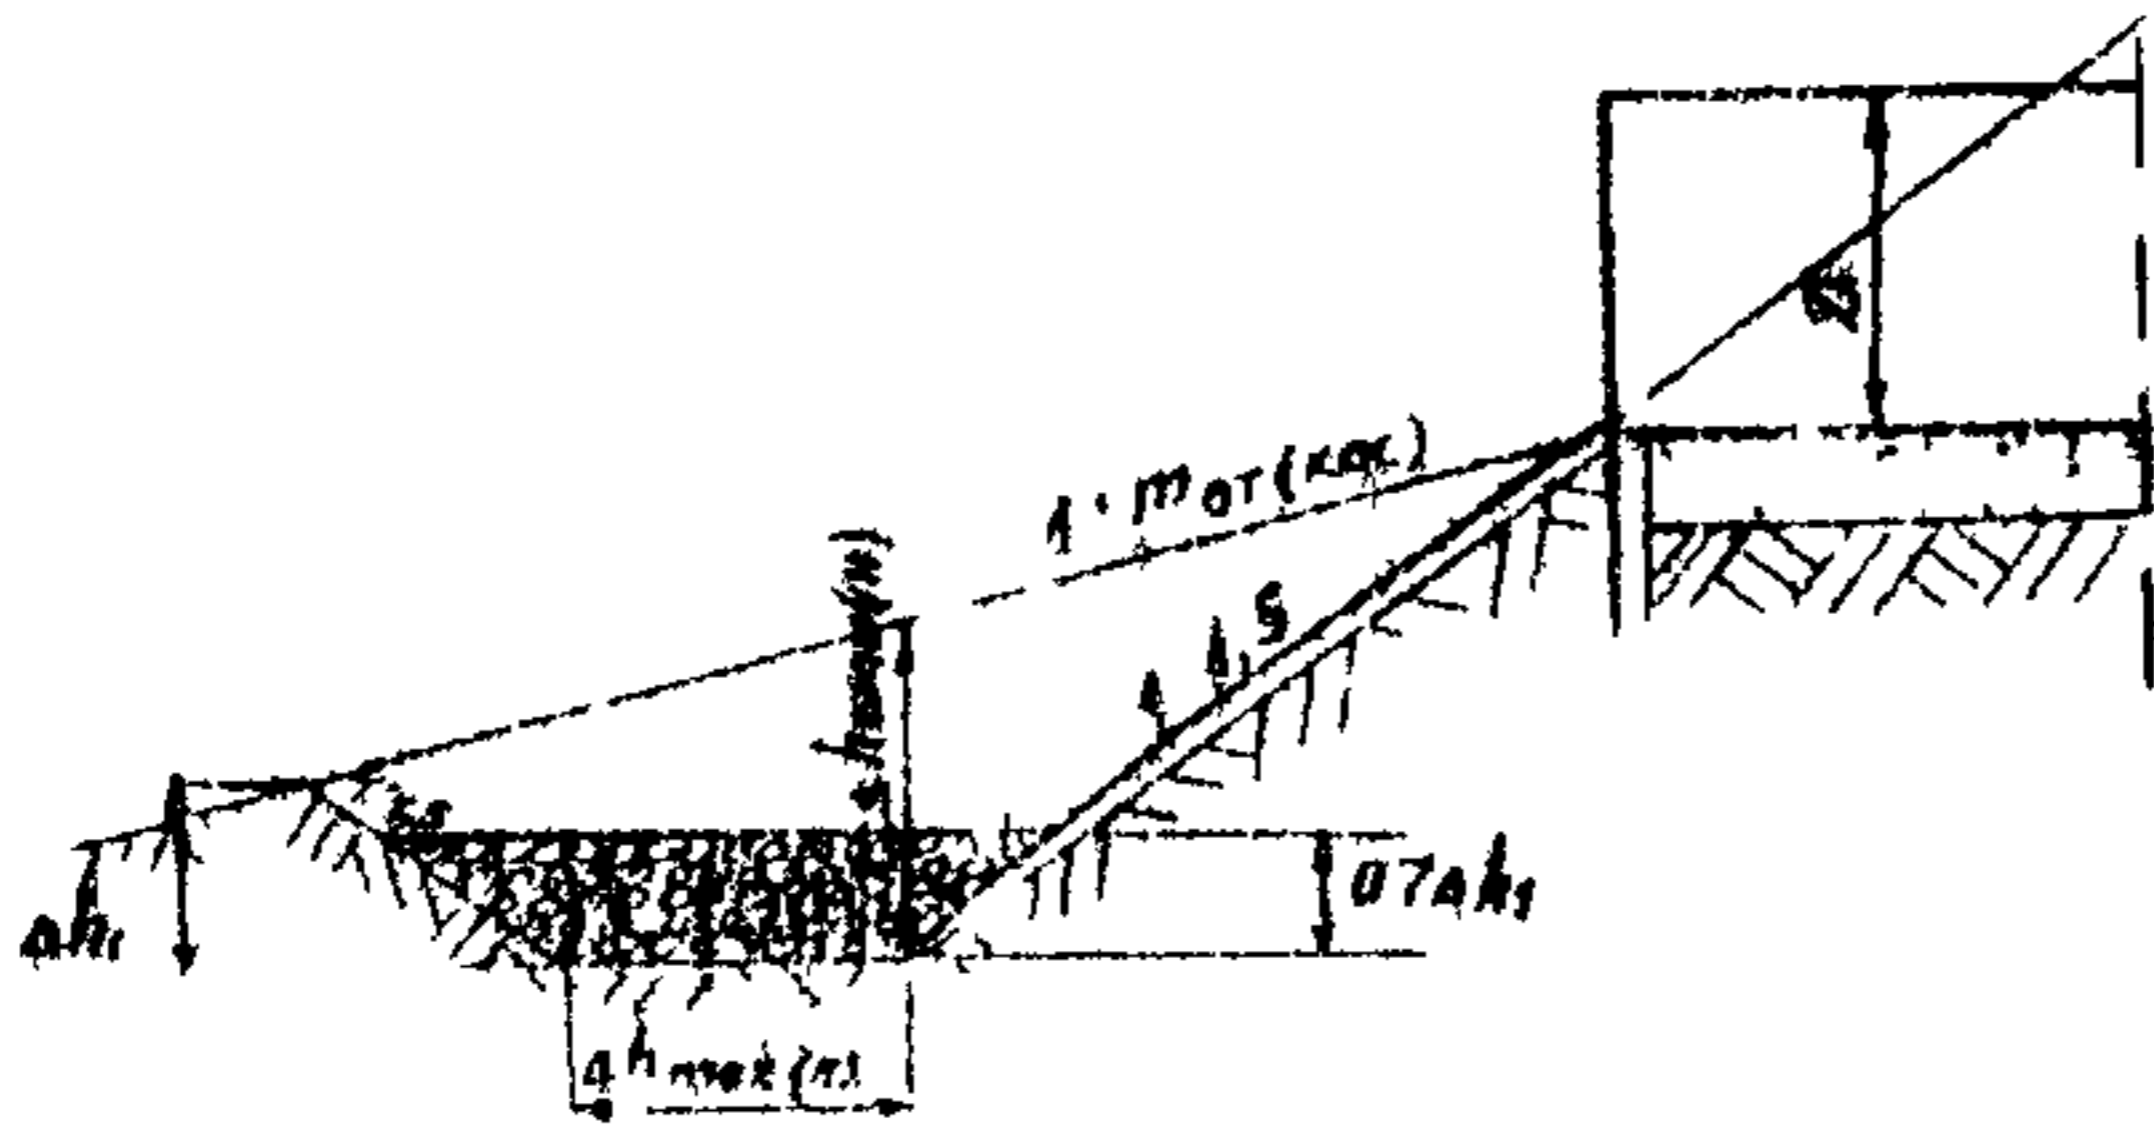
Схема выходных русел из бетонных блоков и каменной наброски на косогорах без укрепления откосов котлована
